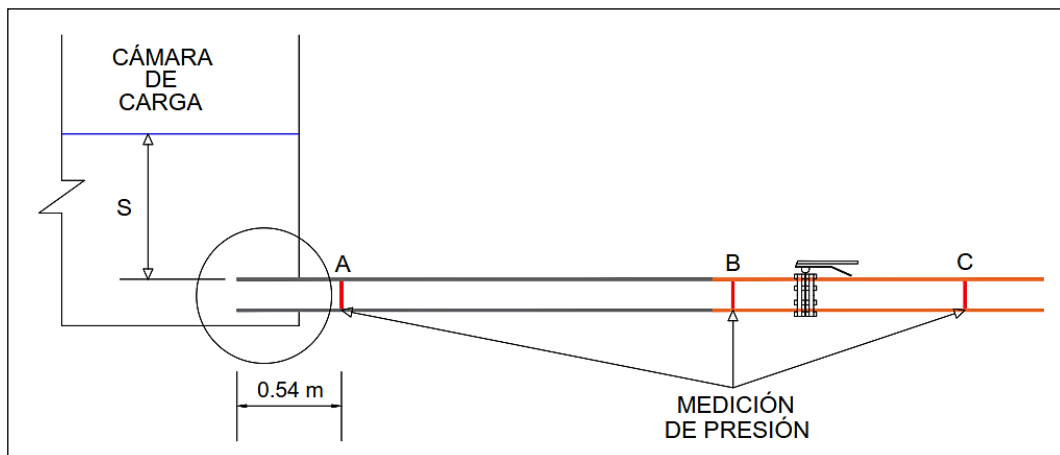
Esquema de la tubería sumergida con entrada de arista viva (recto).
